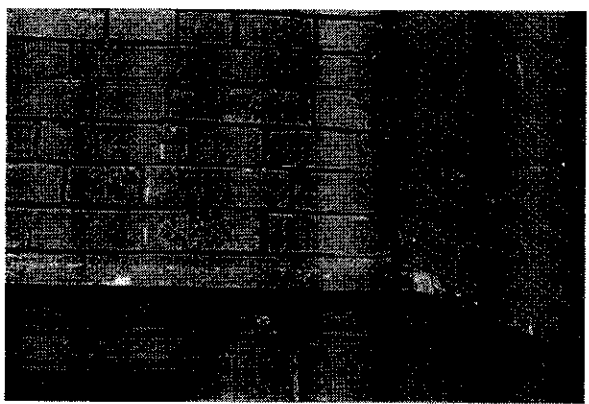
Fisura en la junta de pega de la zona frontal.
